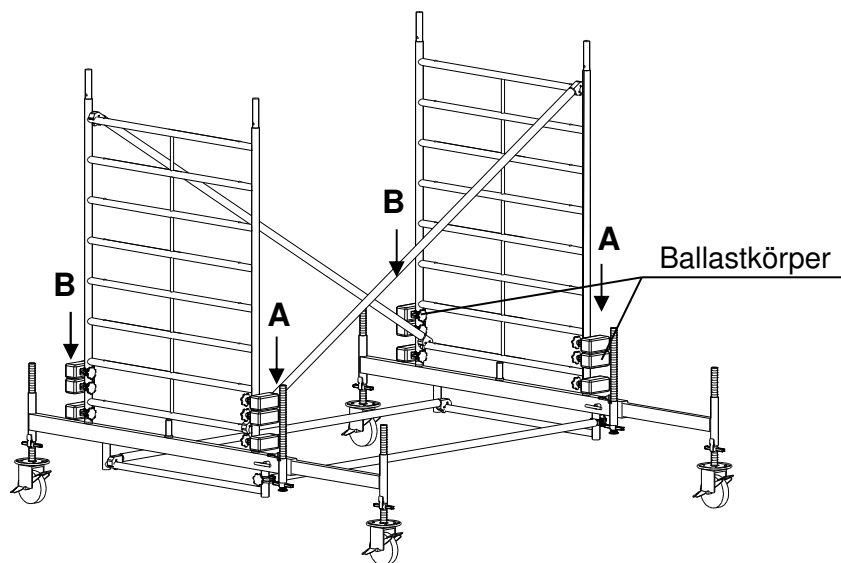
Grundeinheit mit Teleskop-Fahrbalken L228
